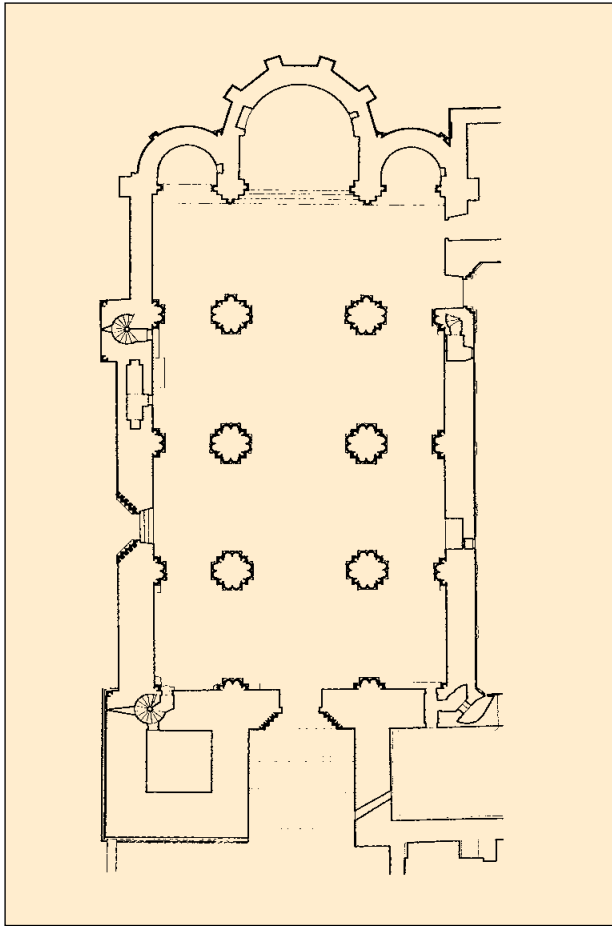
Monasterio de Santa María de Irache, planta al nivel de plintos
